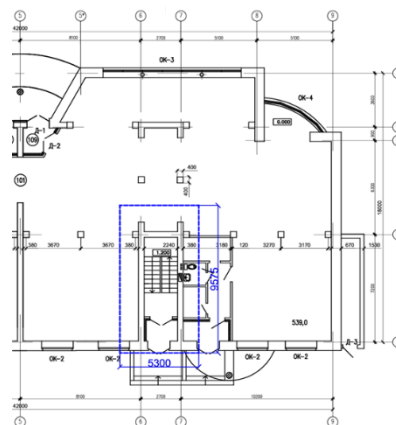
План реконструируемого участка на отметке 0.000, первого этажа
